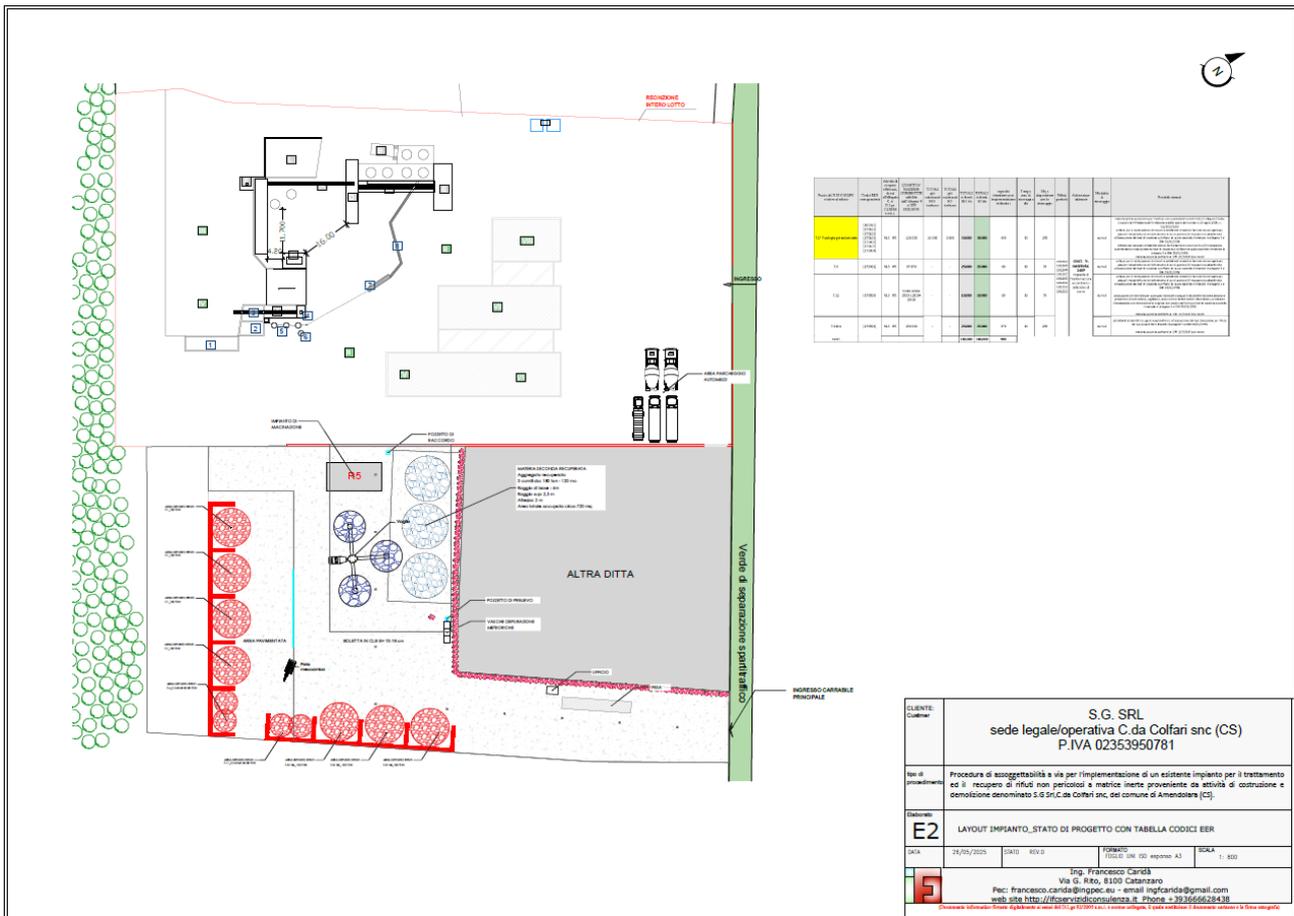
layout impianto stato di progetto con indicazioni sui cumuli
